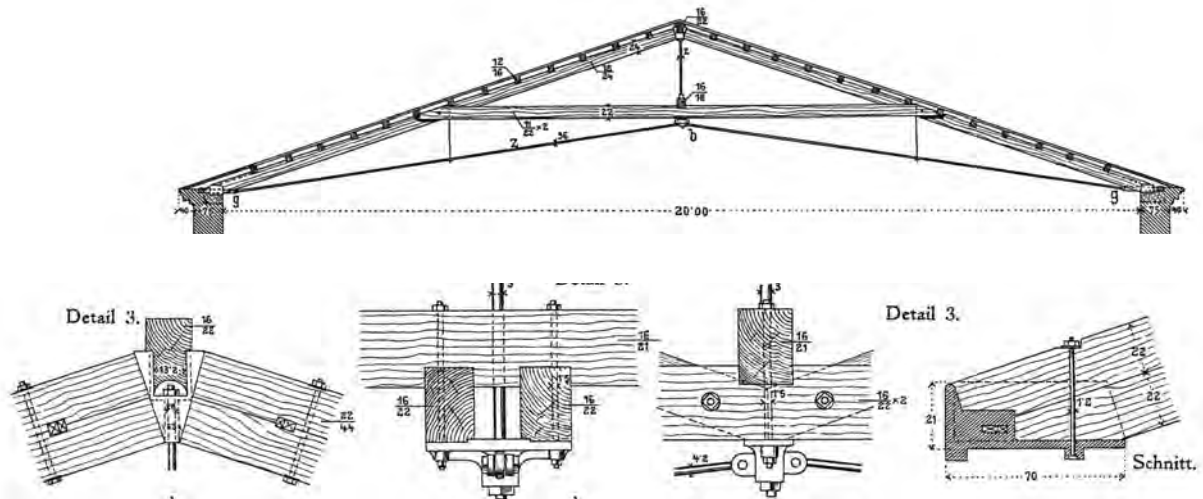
Hallendach aus Holz in Verbindung mit Eisen
